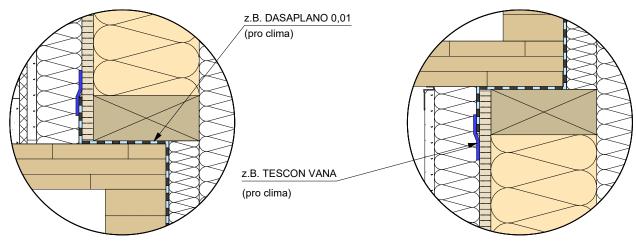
a Schnitt A-A Einlegebrett Holzfaserdämmung Nut-Feder-Profil bauseits eingelegt z.B. DASAPLANO 0,01 (pro clima) z.B. TESCON VANA (pro clima) Planinhalt CLT BOX - DECKE Klebeband (luftdicht) WDVS - Putzsystem KVH Luftdichtheitsbahn Holzfaserdämmung Detail 2.3.a Schnitt A-A Einlegebrett OSB (luftdicht verklebt) Putz oder Beplankung WWW Gefachdämmung Datum Maßstab 07.07.2025 1:10, 1:5
